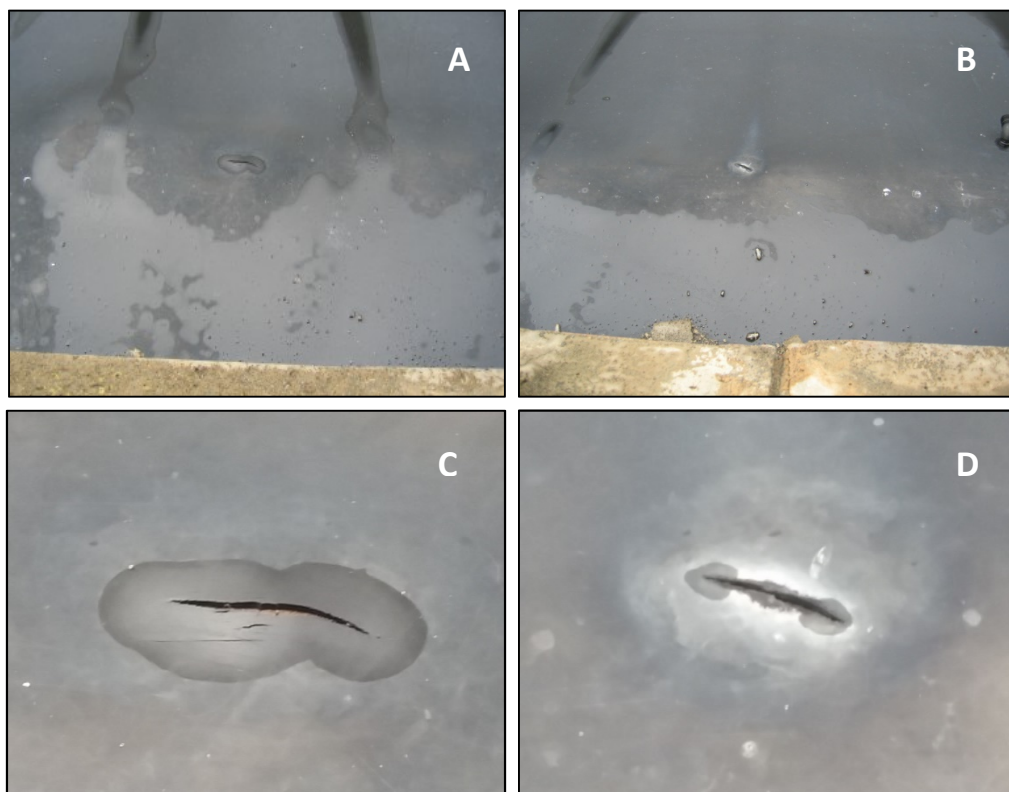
Grietas detectadas en la zona de coronación del embalse de Buen Paso. A y B: zonas de aparición de las grietas. C y D: ampliación de las grietas de las fotografías A y B respectivamente
